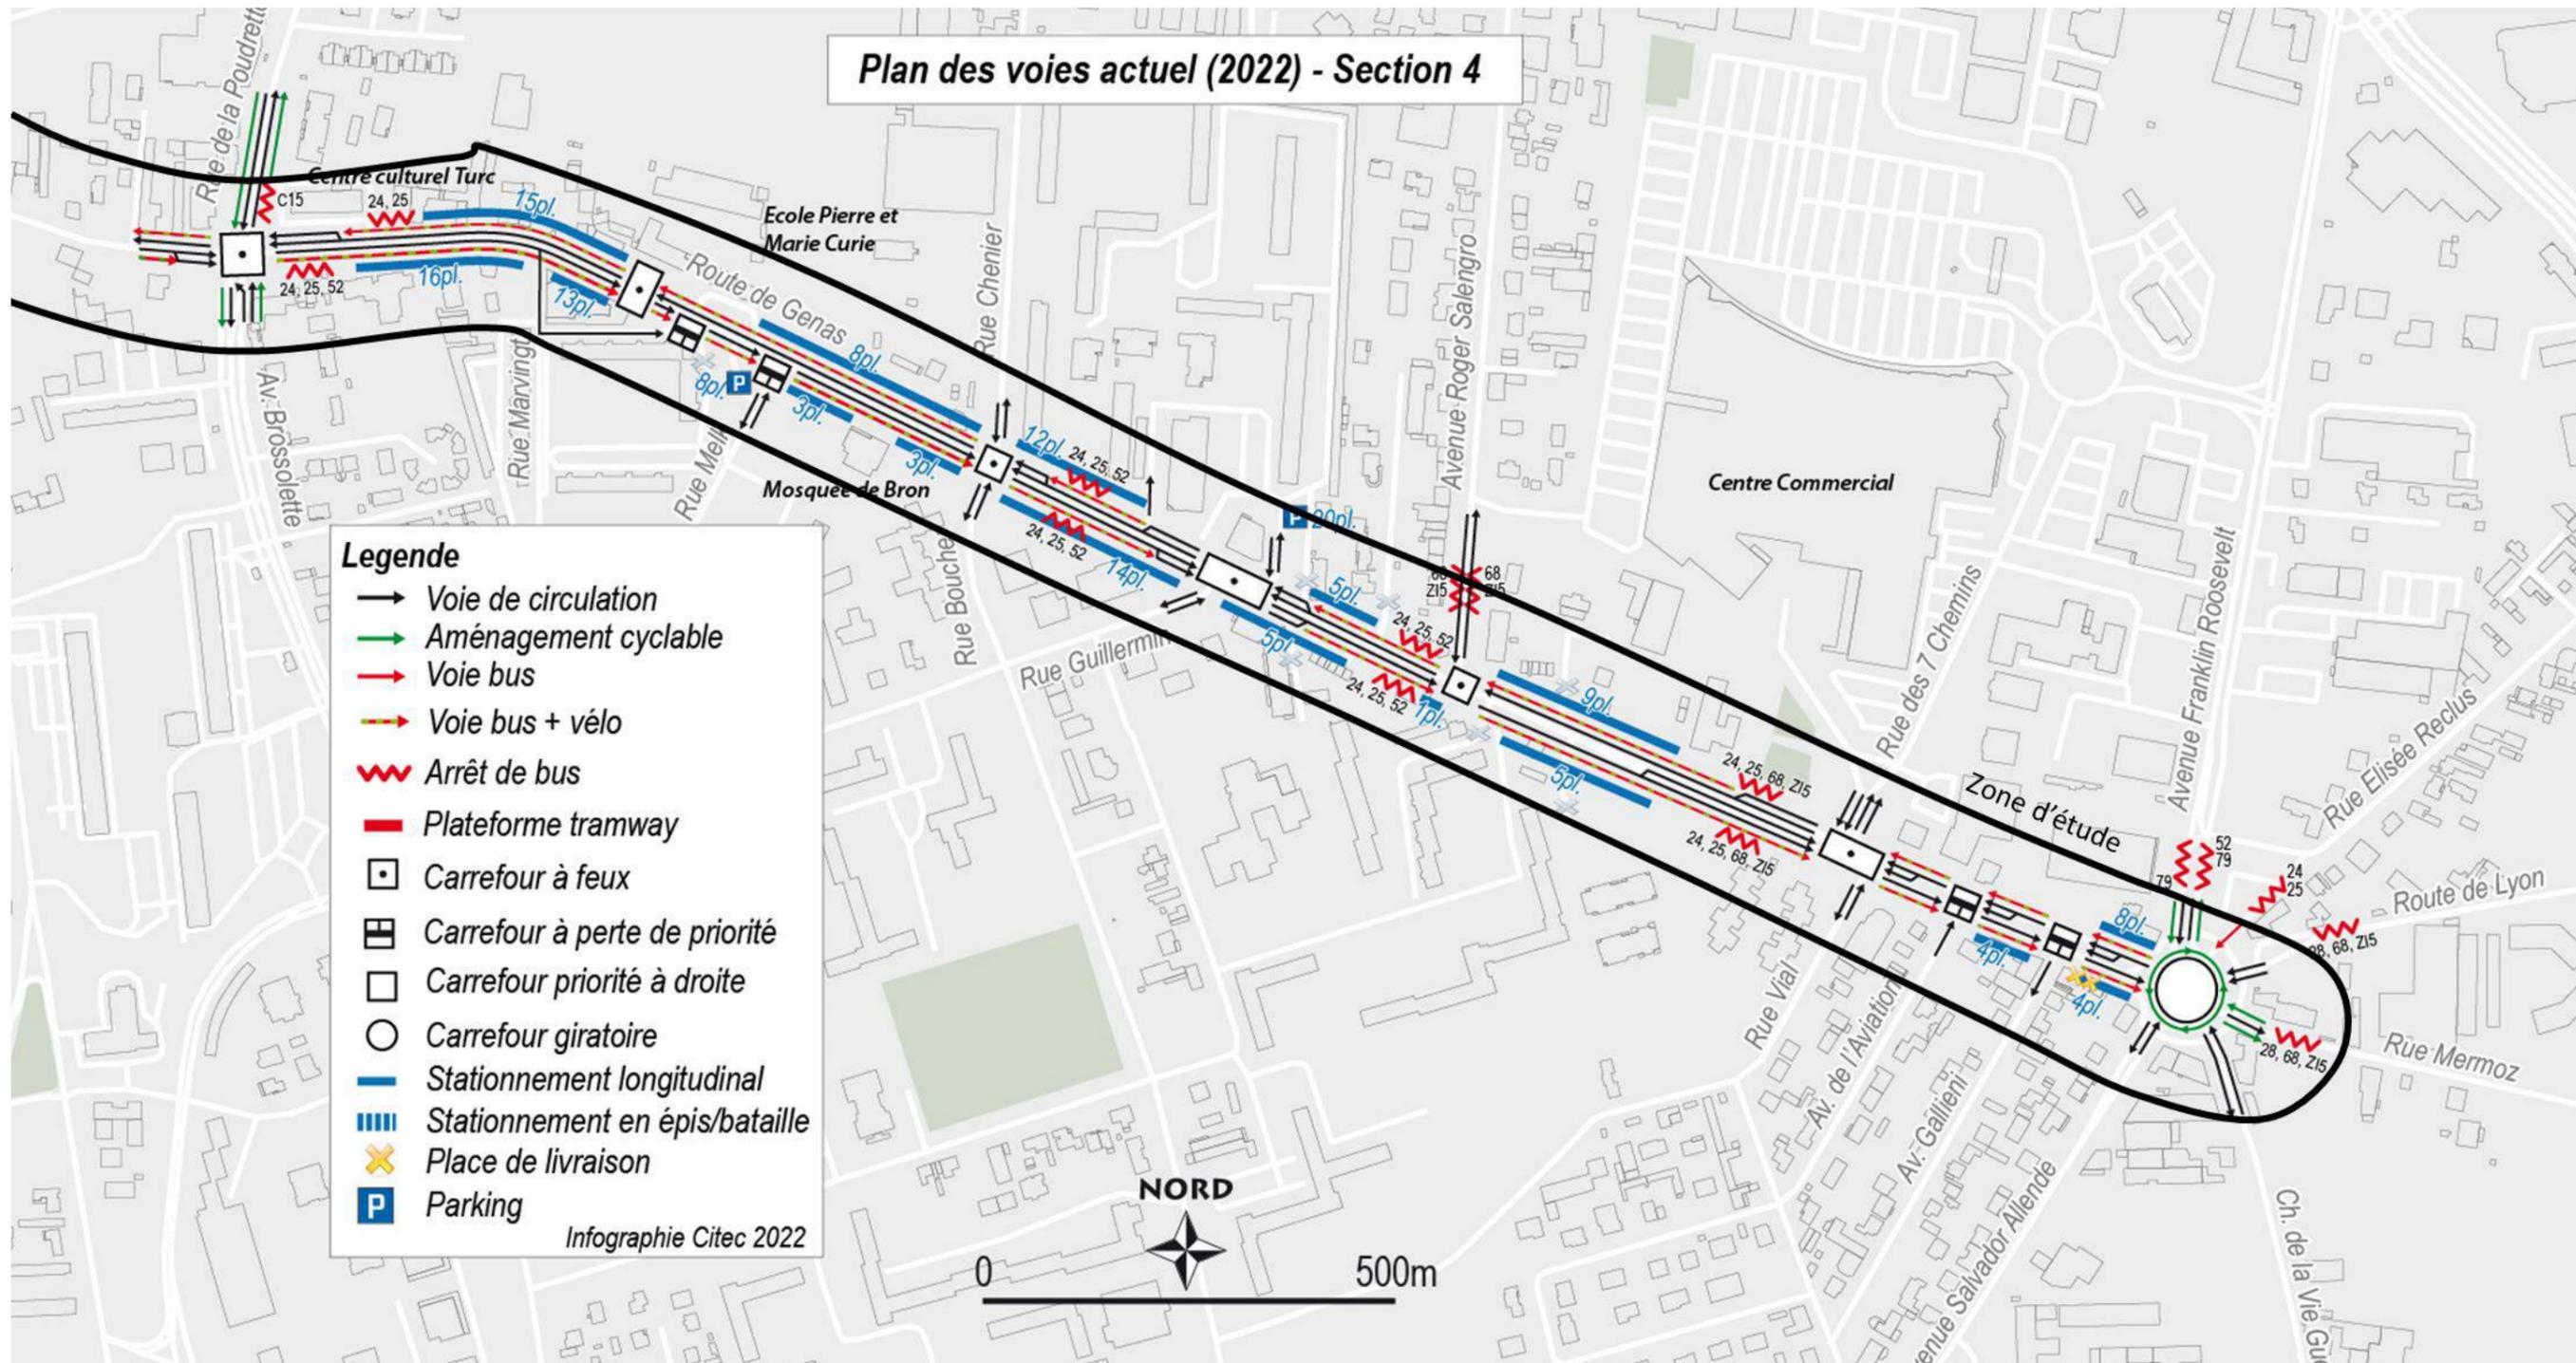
Plan des voies actuel – Secteur 4 Brossolette Genas – Sept Chemins
